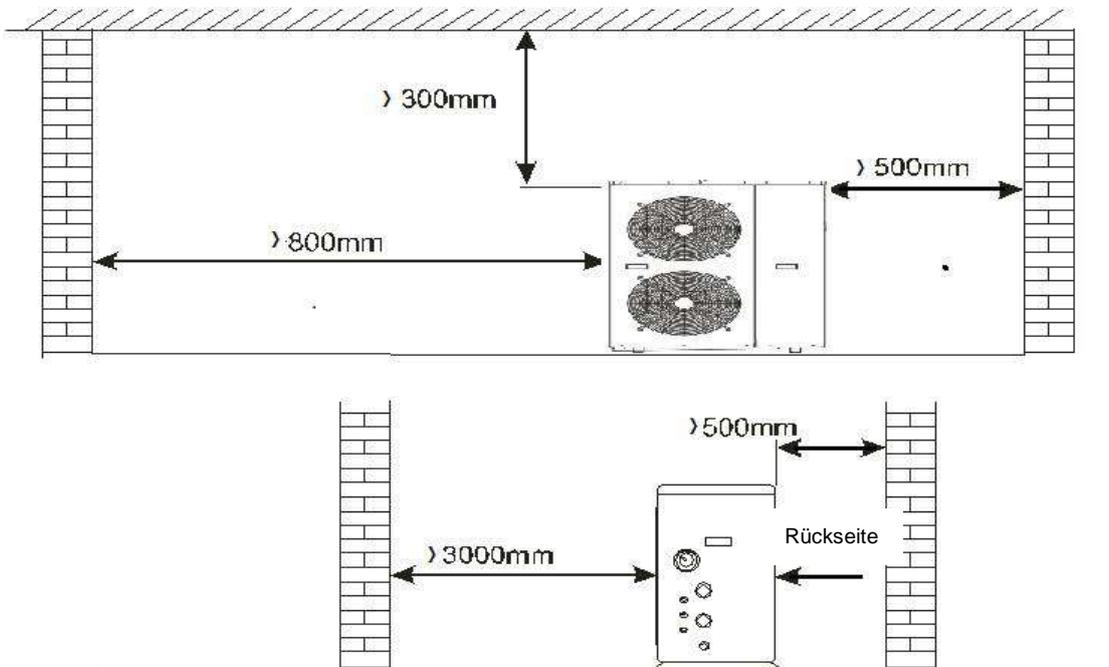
Horizontaler Installationsraum (Einheiten: mm)
